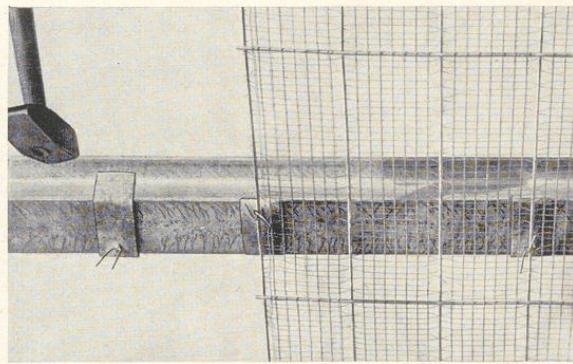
Befestigen der Baustahlmatten an eisernen Trägern mit verzinkten Laschen
